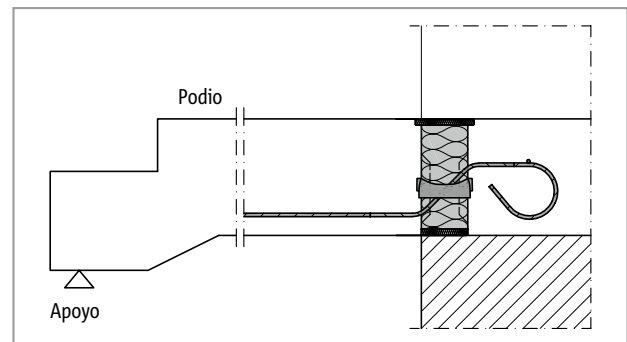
Schöck Isokorb® T tipo Q: Conexión tramo de escalera para muros simples aislantes (p. ej., T tipo Q-V1 hasta Q-V5)
